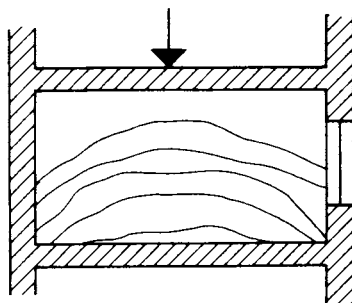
Возникновение трещин в результате воздействия на конструкцию перекрытия повышенных нагрузок
